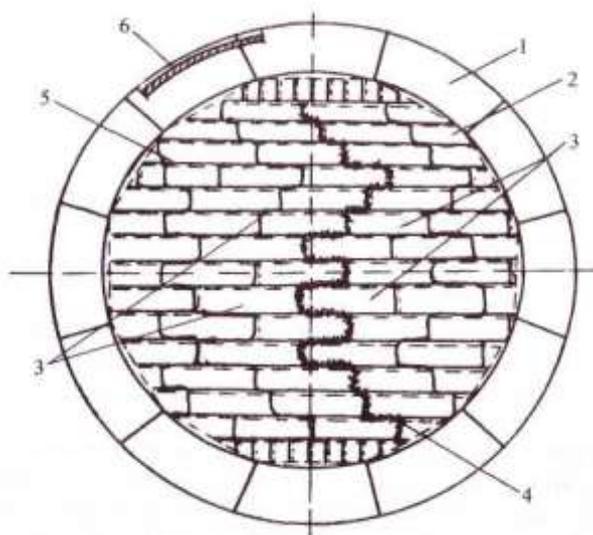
Схема сборки и сварки днища из листов: 1 — крайка; 2 — периферийные листы; 3 — зона; 4 — шов между зонами; 5 — шов между периферийными листами и зонами; 6 — стенка
